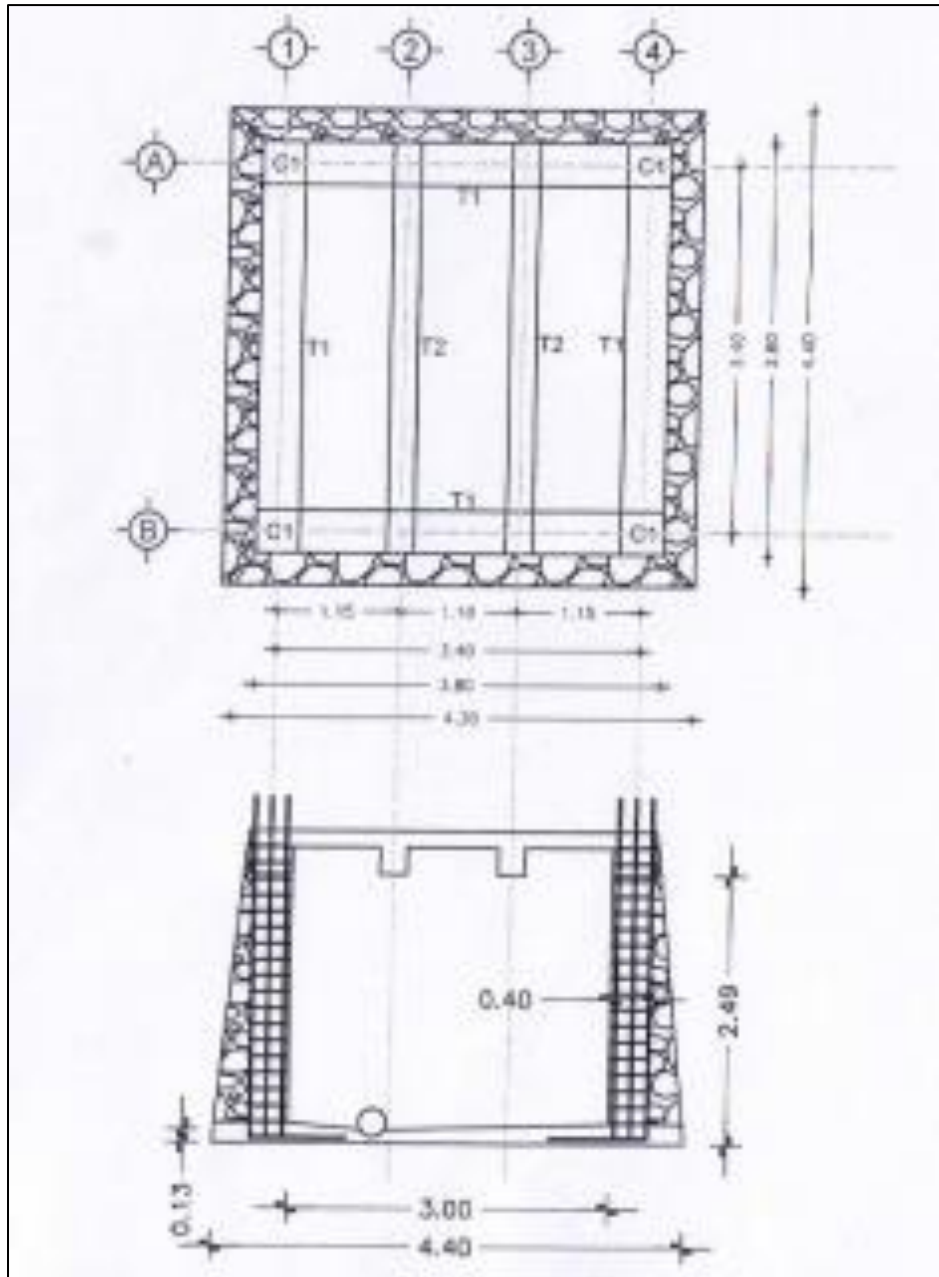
Trazo de planta y perfil de caja concentradora. Fuente: H. Ayuntamiento de Amatlán de los Reyes, Ver.
